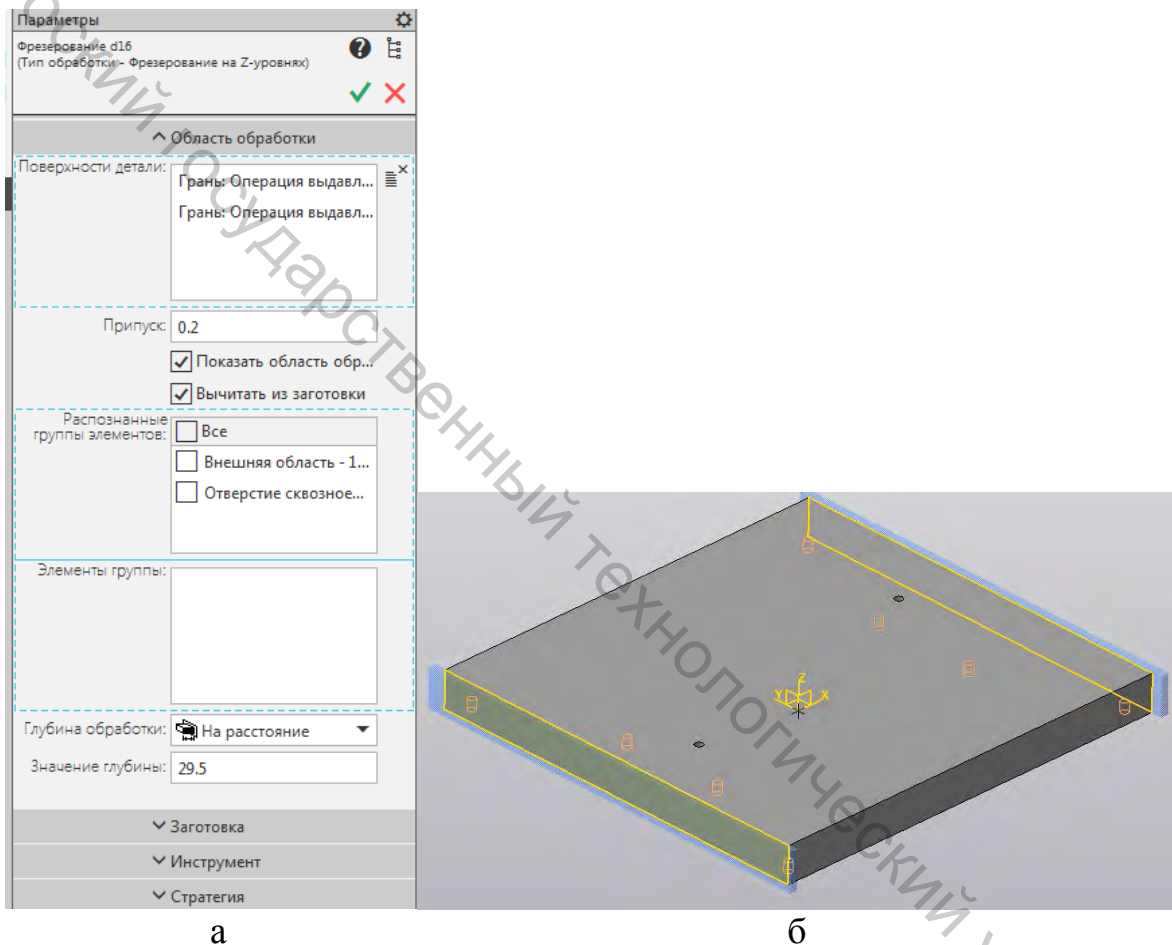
Создание операции фрезерования торцов заготовки:
